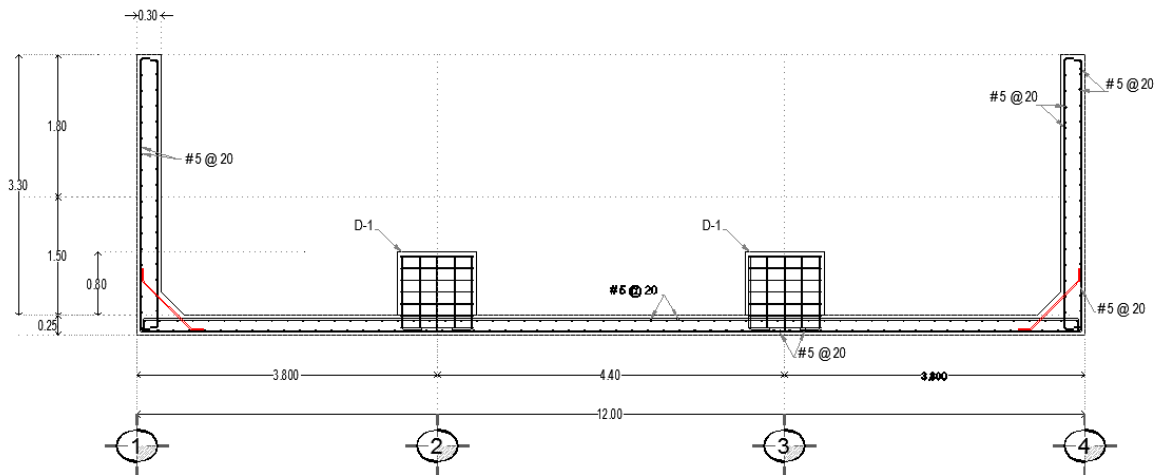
Arreglo estructural para silenciador de rechazo de carga (Vista lateral)
